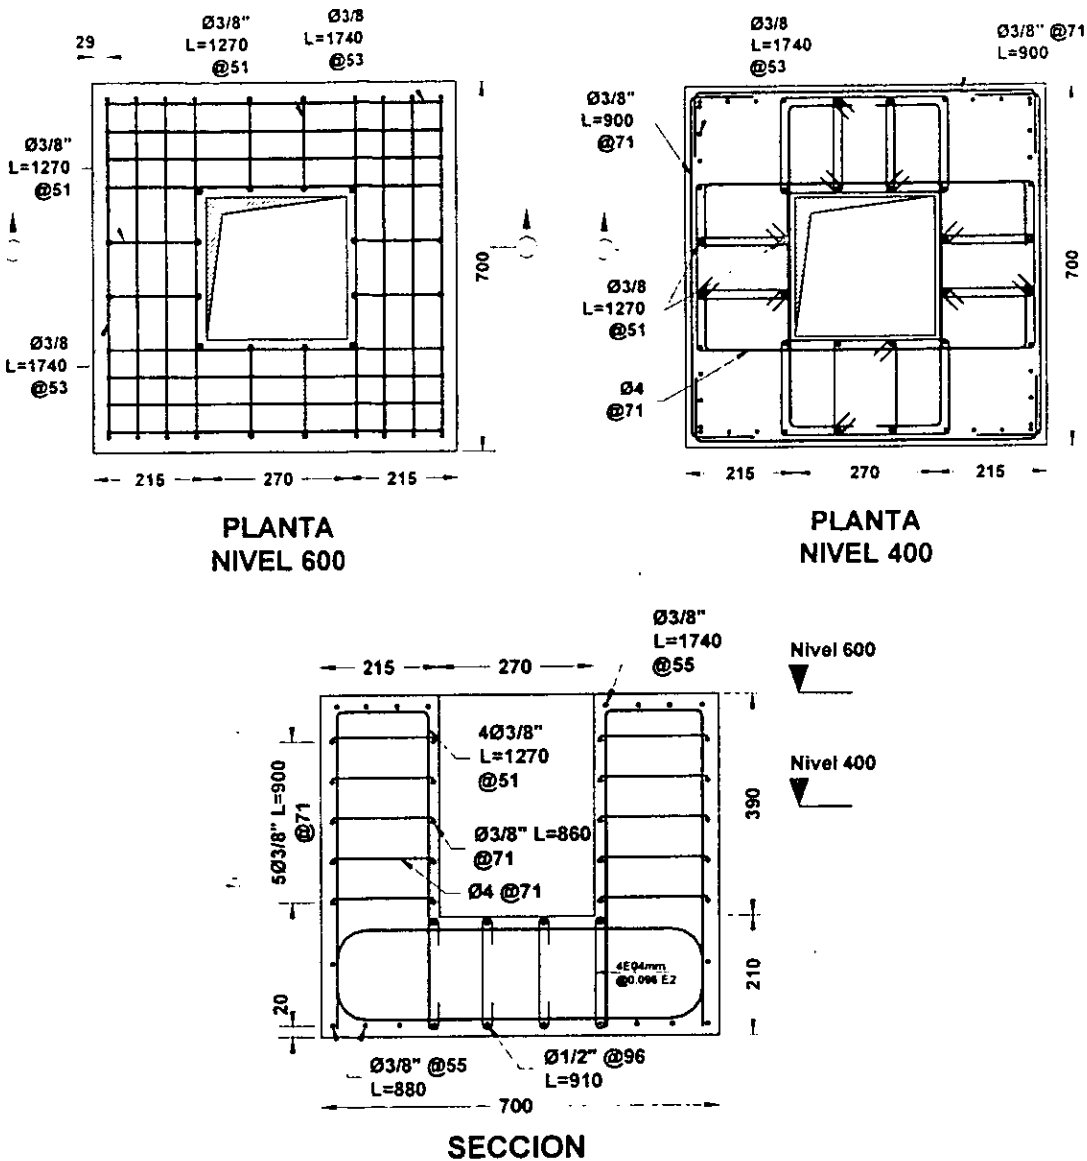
Detalles de refuerzo en los elementos estructurales (continuación)
